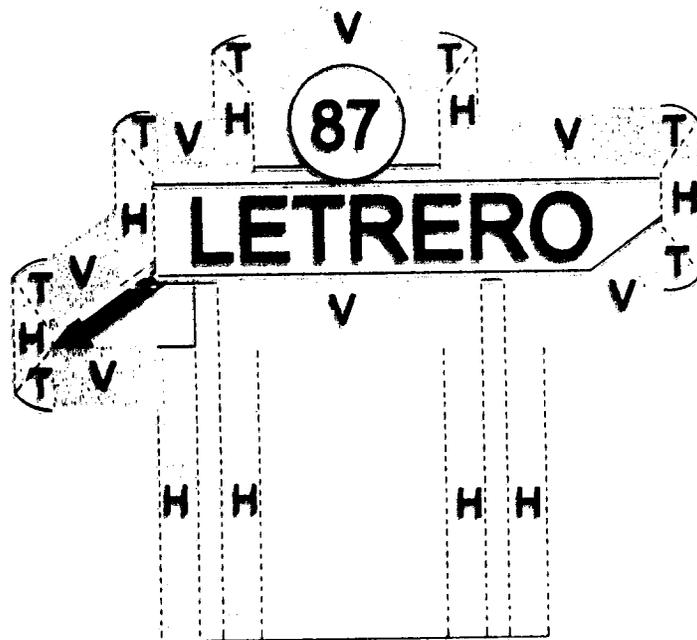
FIG. (B) SEPARACION DE OTRAS ESTRUCTURAS
